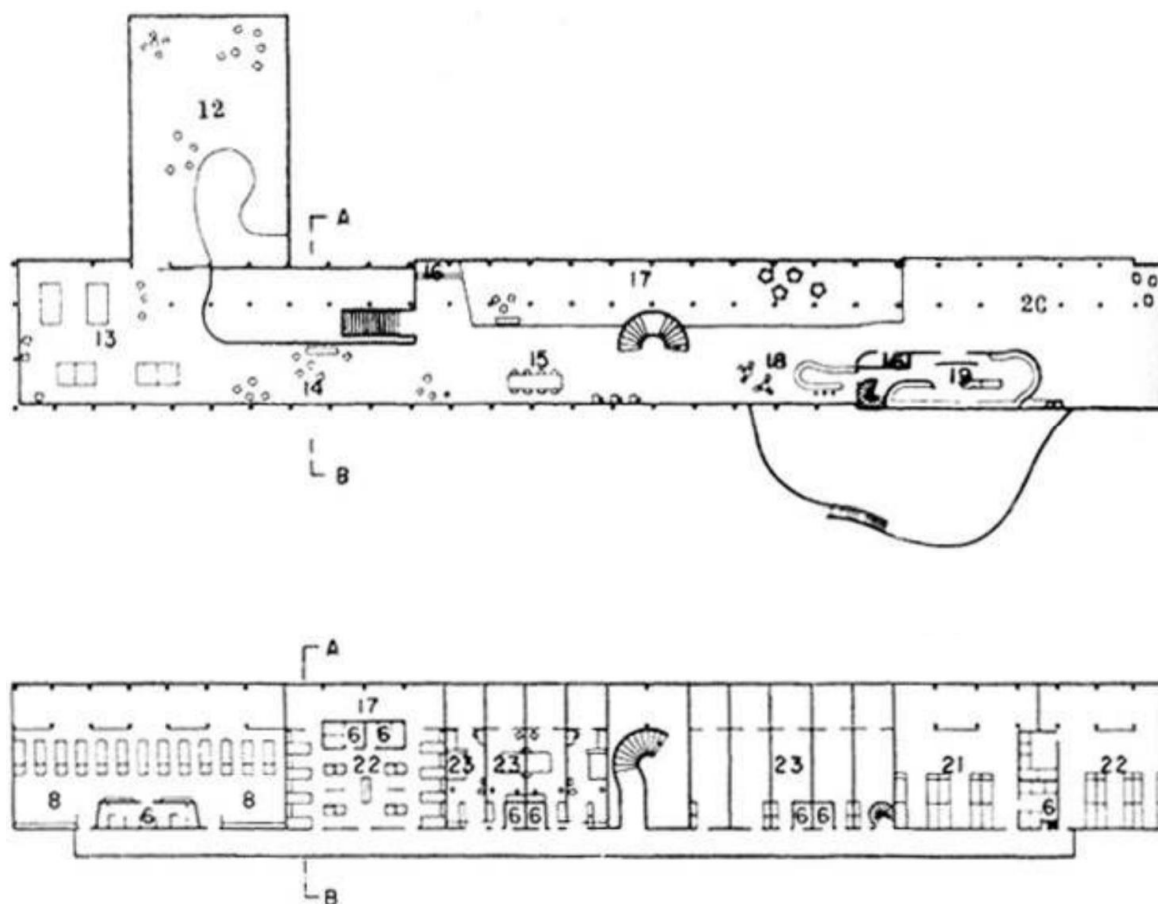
Plantas do 1º e 2º pavimentos da Colônia de Férias do IRB.
